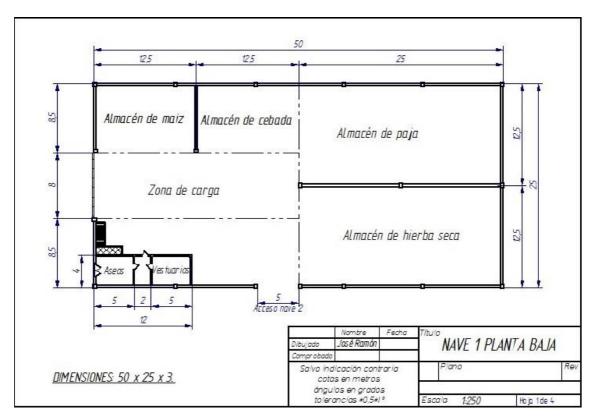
Nave 1-Planta baja. Fuente: Planos proporcionados por el técnico
